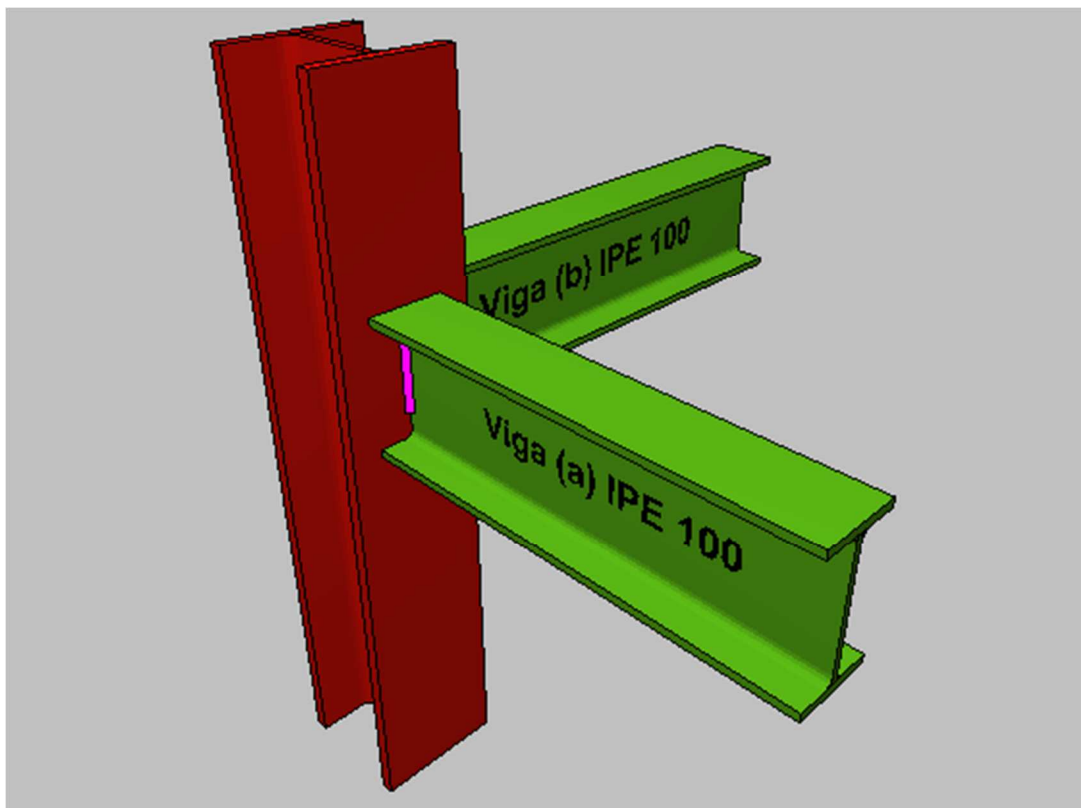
Unión tipo 2 escaleras. Viga-pilar-viga
